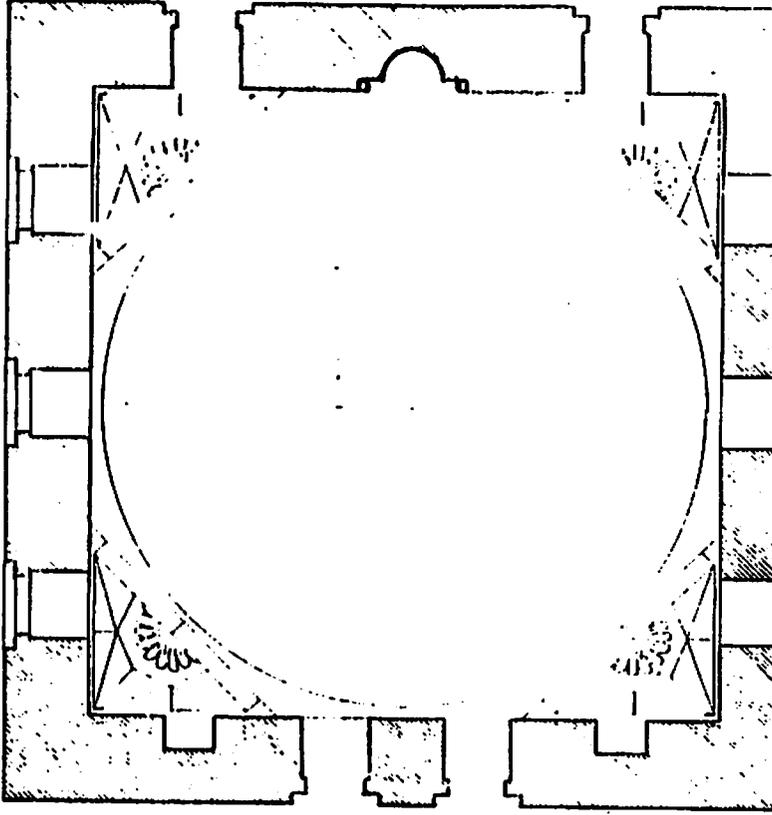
مسقط أفقى لقبة جانى بك الأشرفى عن هيئة الآثار
